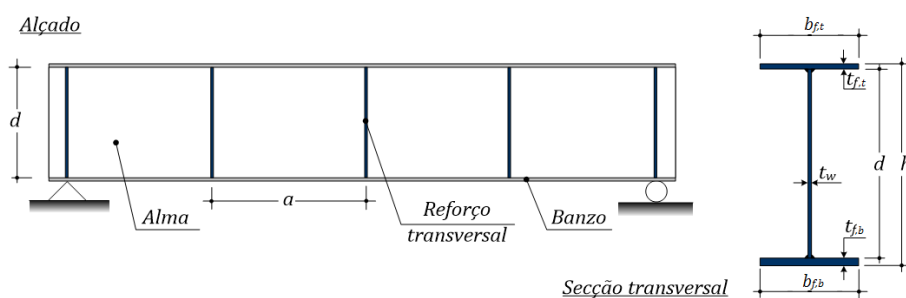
Viga de secção soldada. Adaptado de [3]
